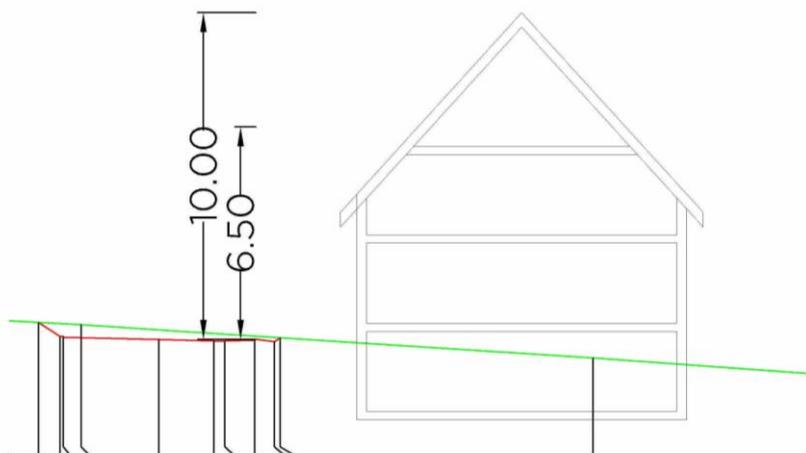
Systemschnitt zur Definition des Bezugspunktes für Sattel-, Walm- und Zelt Dach
